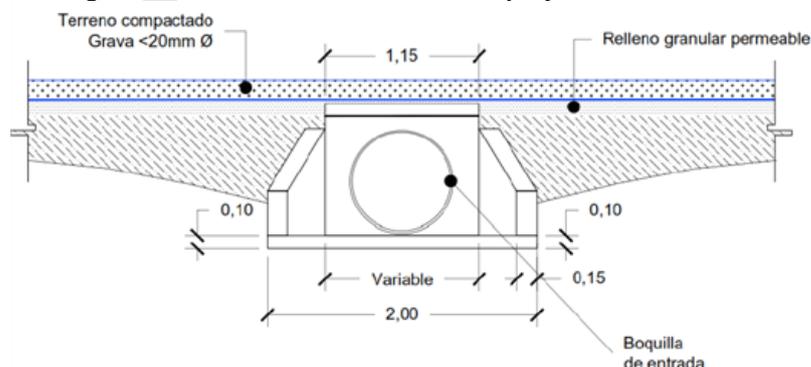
Corte Longitudinal LTE – Obra Tipo II (Bajo Tubería)
